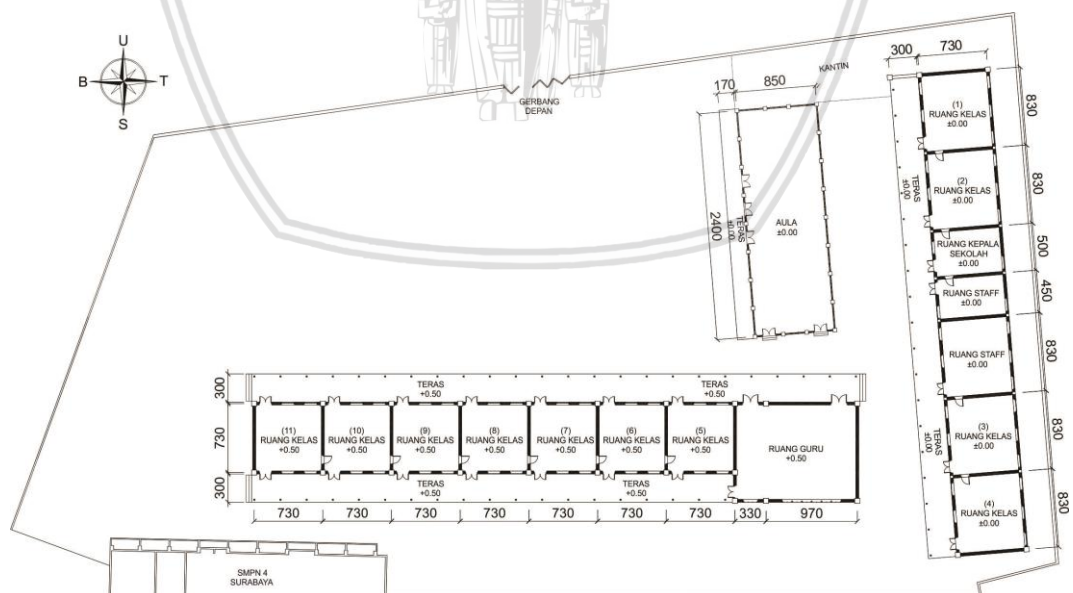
Denah Massa A SMPN 3 Surabaya
